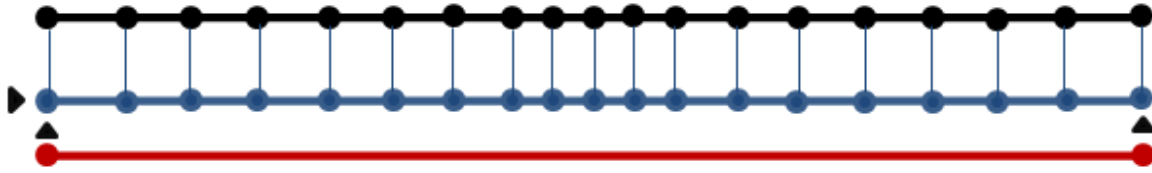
Viga B4 (Lorenc e Kubica, 2006)
